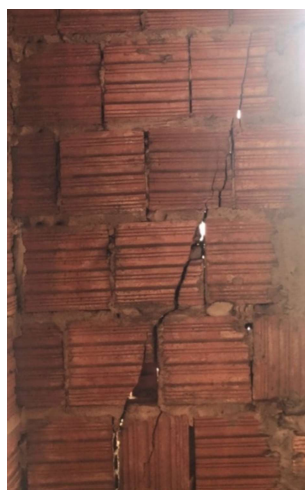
Fissuras em alvenaria. (Arquivo Pessoal, 2020).
